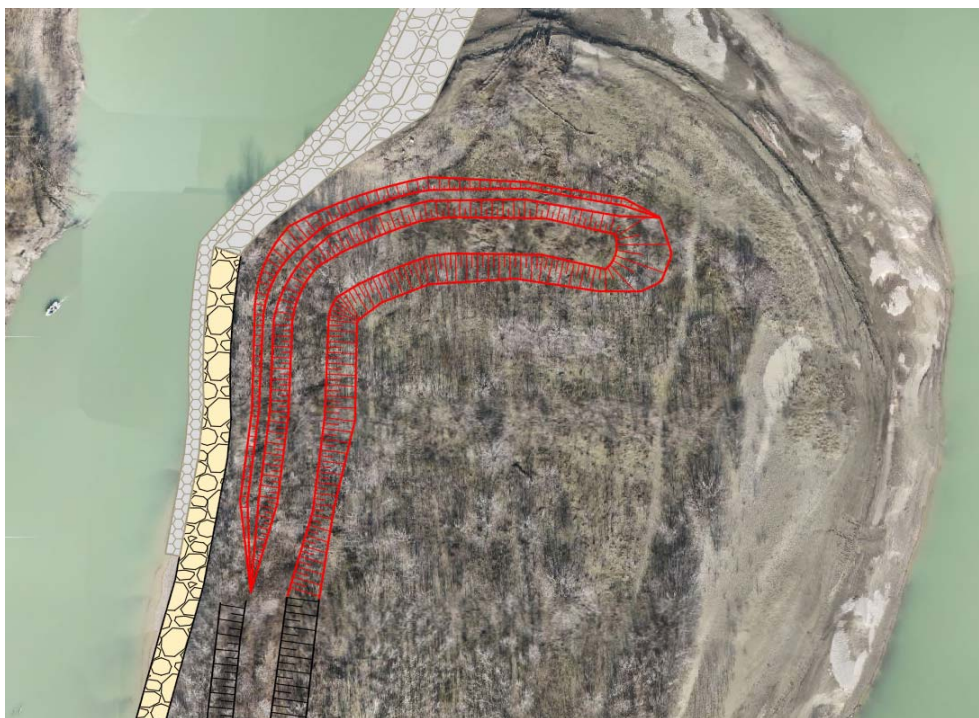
Estratto Tav.PFTE.22 – Planimetria Opera 7
